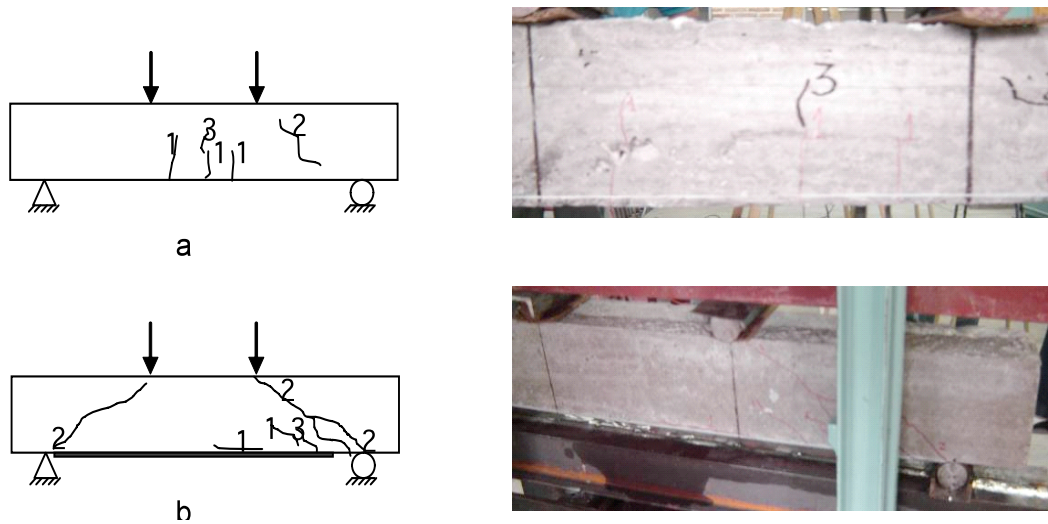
Esquema de fisuración: a) Viga de referencia; b) Viga reforzada
